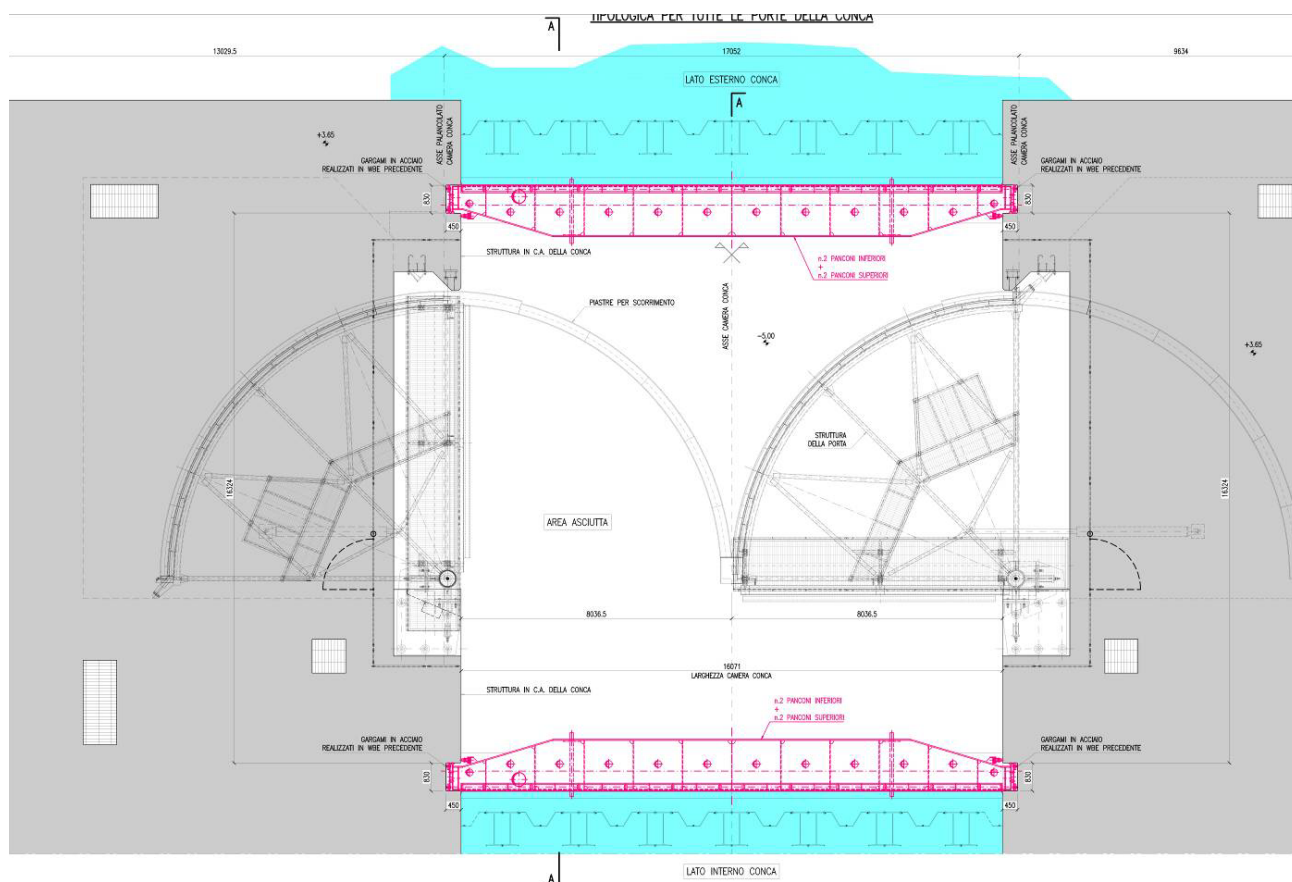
PIANTA TESTATA CONCHE – ZONA DI MESSA ALL'ASCIUTTO PER MANUTENZIONE PORTE
